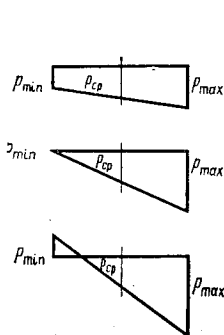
Эпюры давлений по подошве внецентренно нагруженного фундамента
